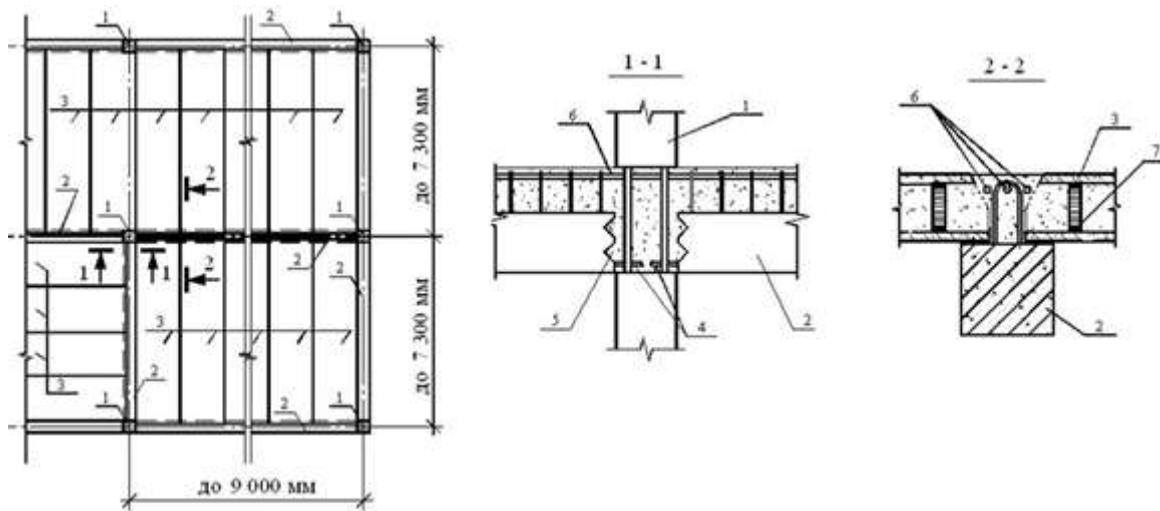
Конструктивні рішення стиків збірно-монолітної системи: 1 – колона; 2 – збірний елемент ригеля; 3 – багатопустотна плита перекриття; 4 – випуски поздовжньої робочої арматури; 5 – шпонки в торці ригеля; 6 – опорна робоча арматура збірно-монолітного ригеля [21]
